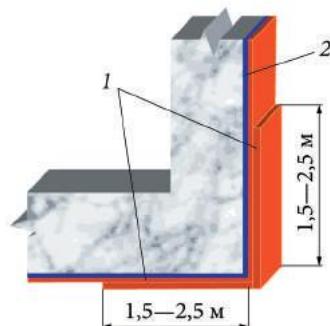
Увеличение толщины теплоизоляционного слоя в угловых зонах (вид угла сверху): 1 — XPS плиты; 2 — гидроизоляционное покрытие
